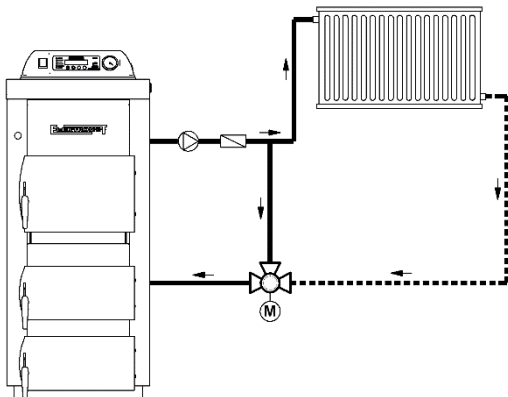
Przykład montażu zaworu mieszającego czterodrożowego
